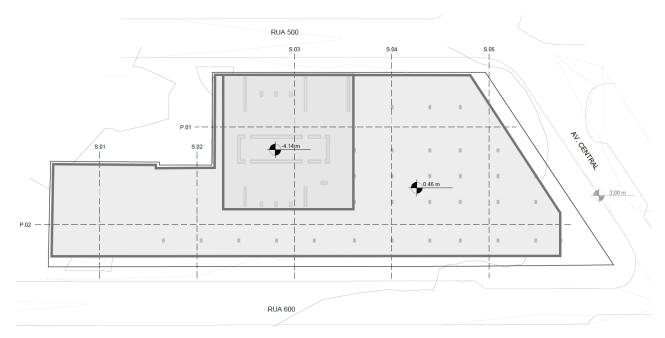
Desenho em planta com estimativa das implantações do subsolo e bloco central de fundação.
